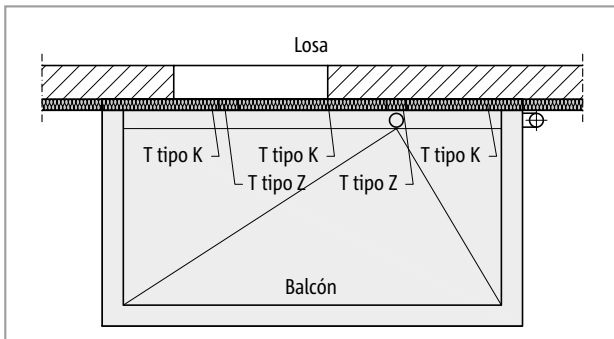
Schöck Isokorb® T tipo Z, K: Recorte para drenaje con Schöck Isokorb® T tipo Z
